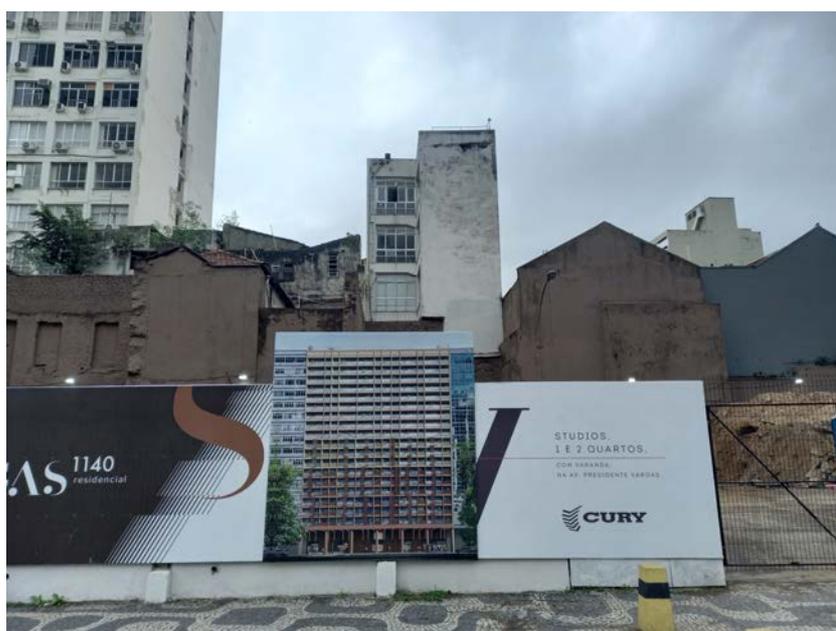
Terreno do edifício Vargas 1140. Fonte: Acervo pessoal.
